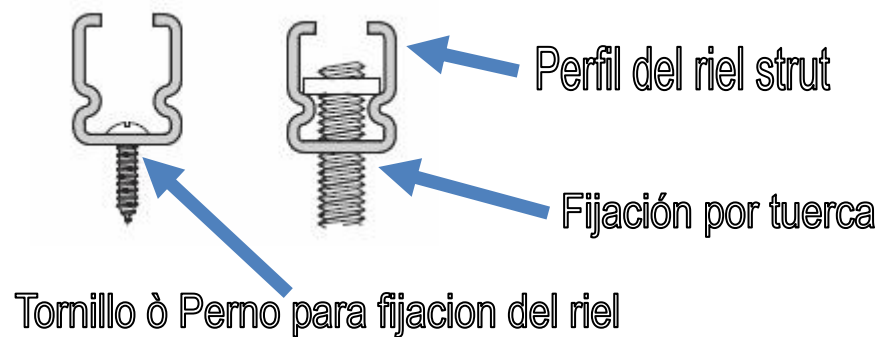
Detalle del montaje del riel strut para fijarlo al techo
